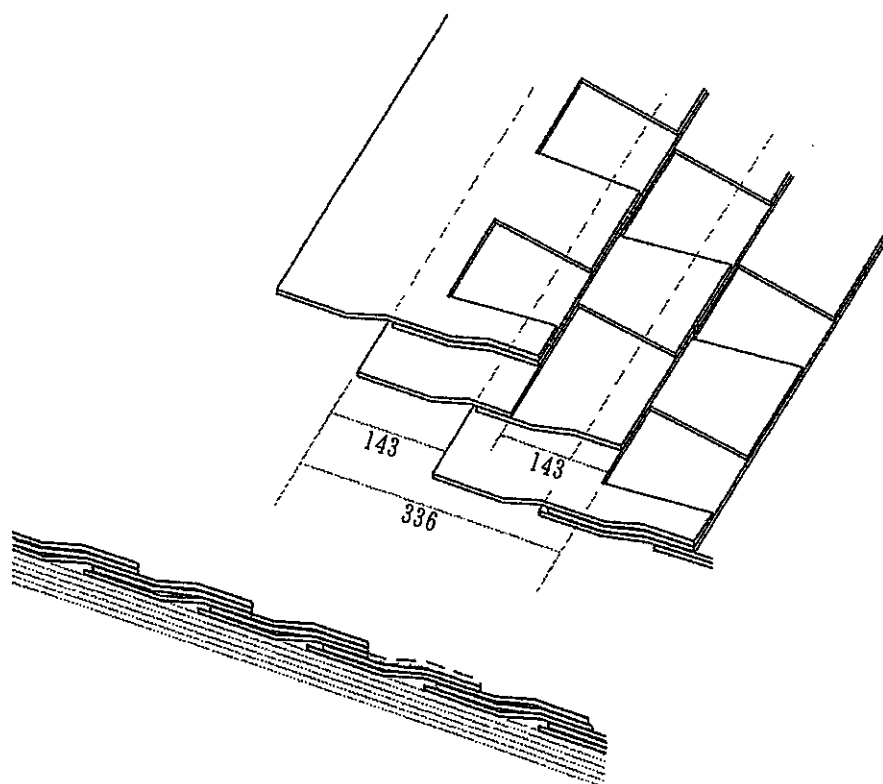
申請仕様の施工図 (アスファルトシングルの施工: コンポジットタイプ)
